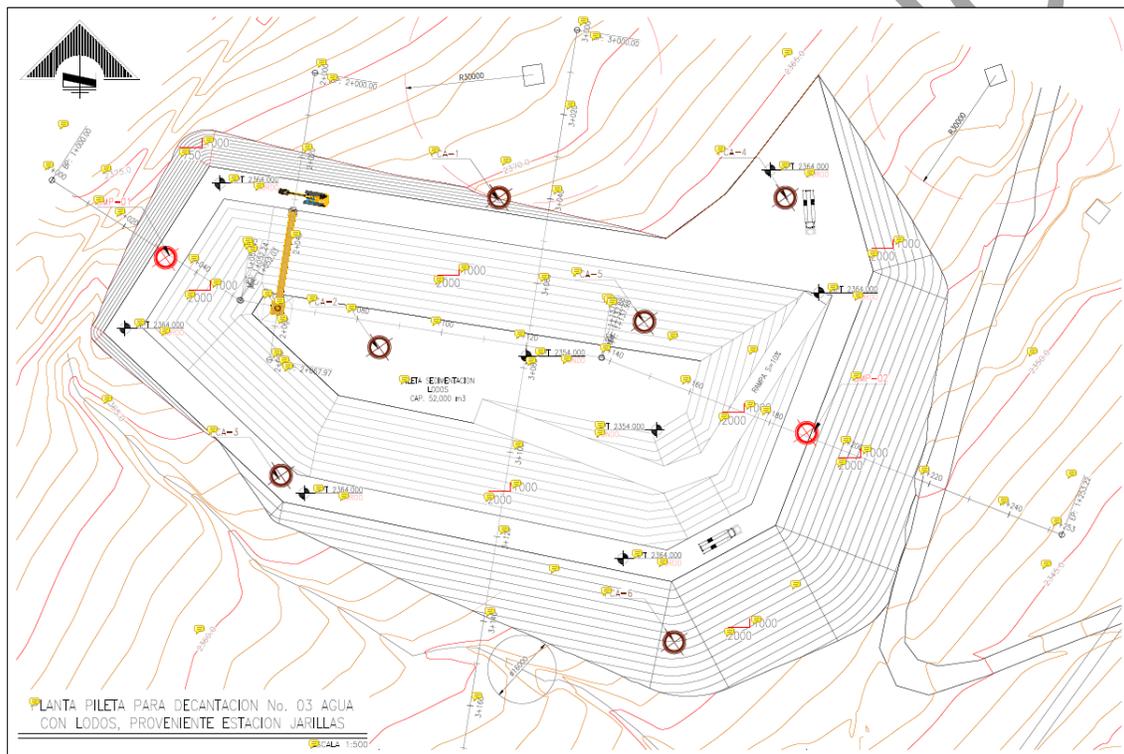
Ubicación en planta de la Piletta de lodos 1414.
